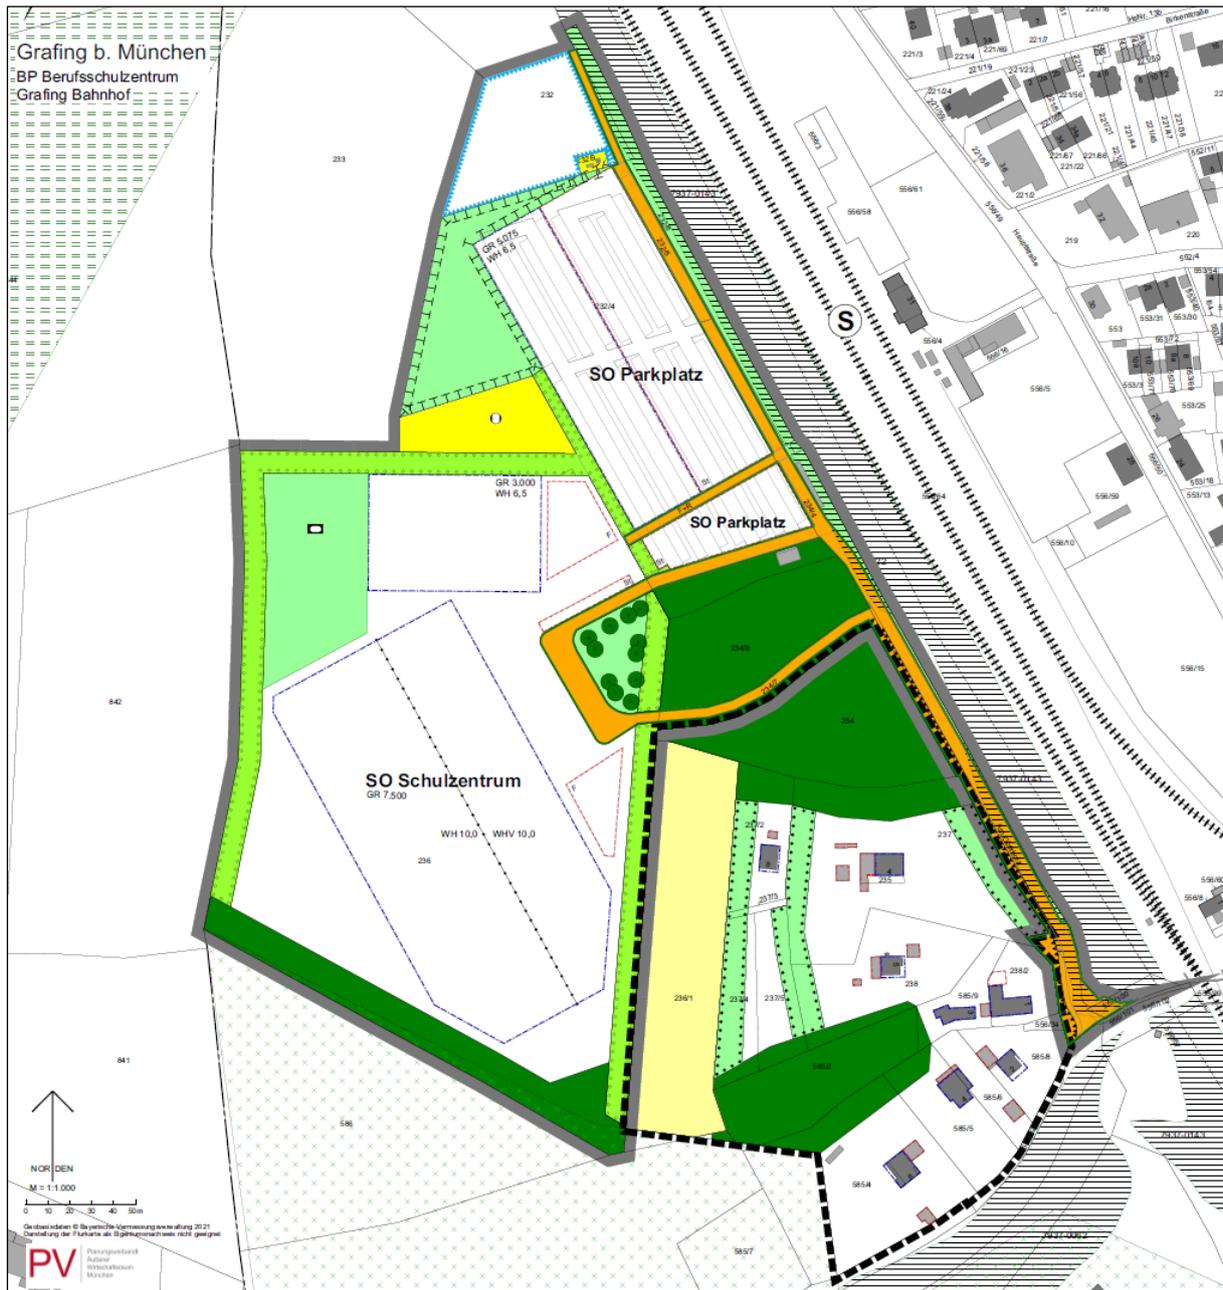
Lage des geplanten Bauvorhabens am westlichen Stadtrand von Grafing
